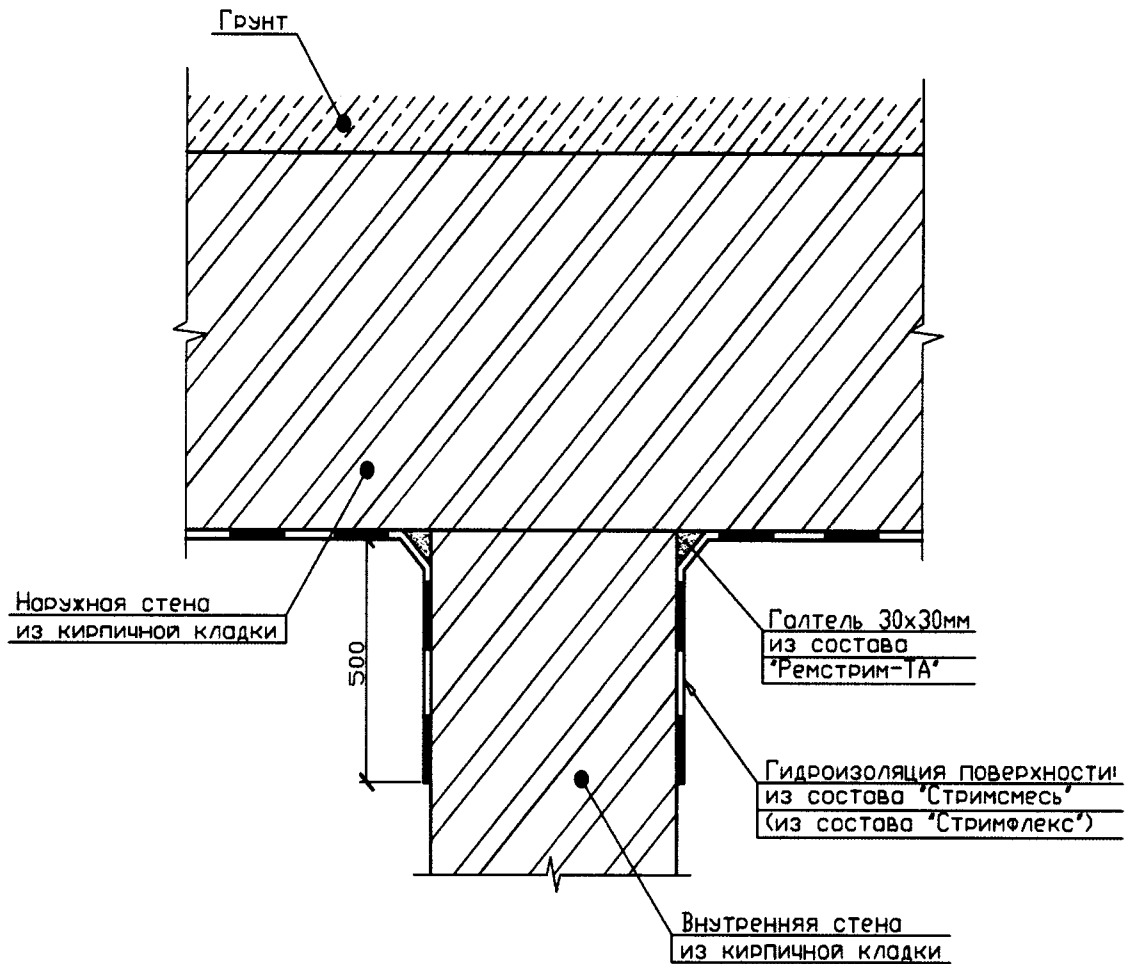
Гидроизоляция поверхностей конструкций из кирпичной кладки.
